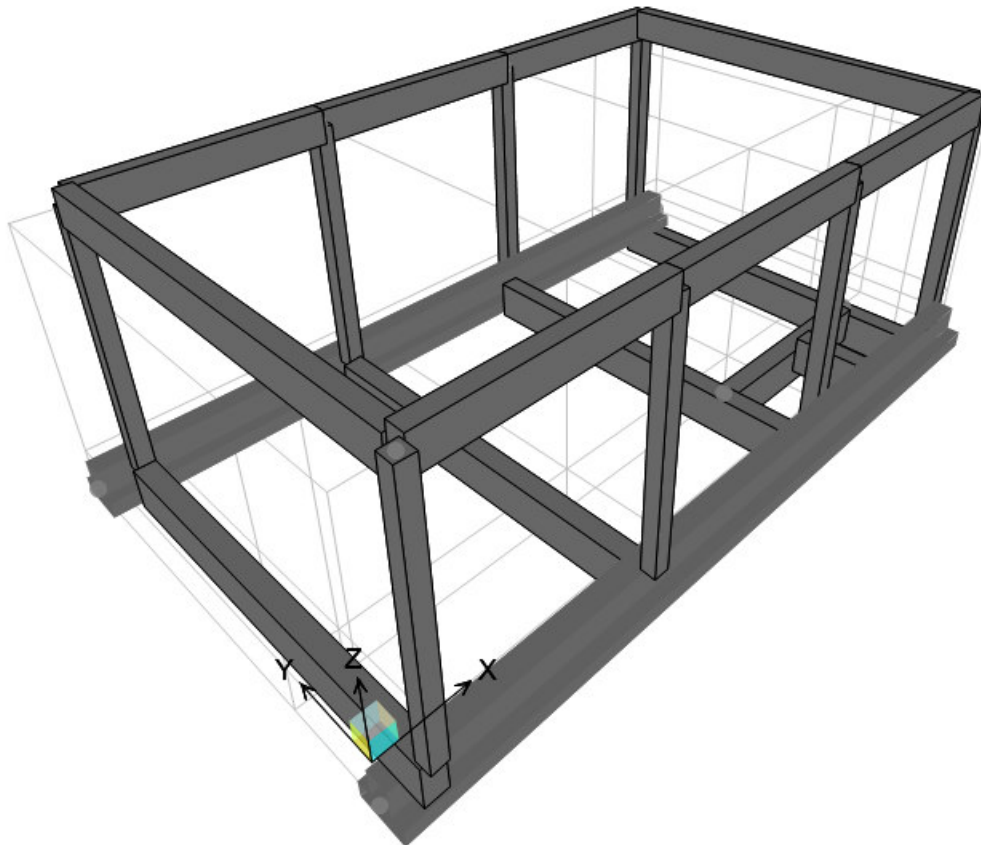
Modello - Vista assonometrica estrusa struttura - elementi frame
